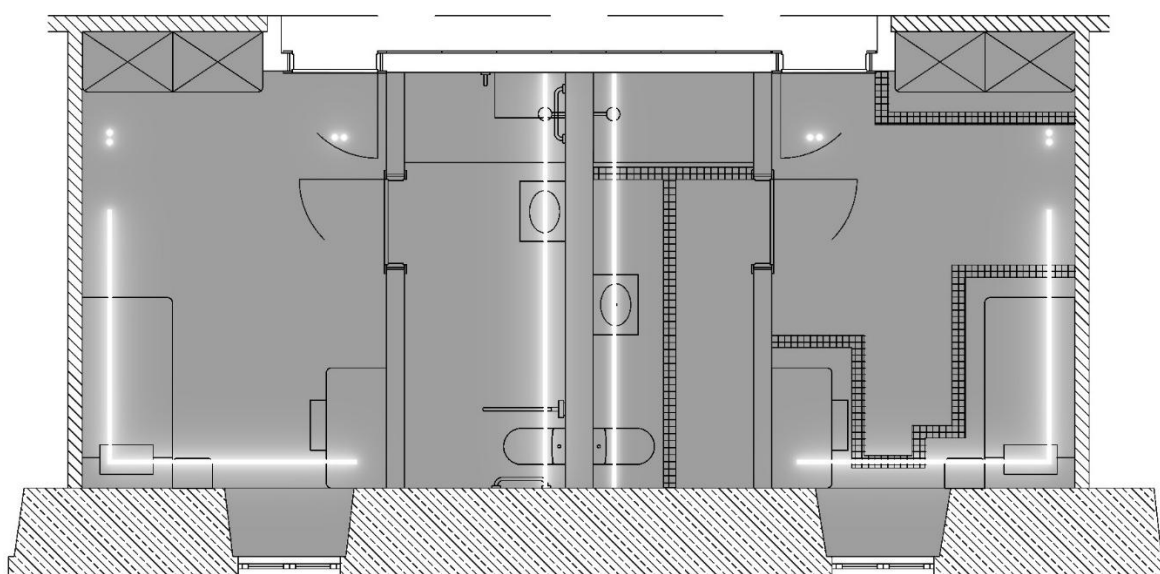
Planta de Iluminação; Fonte – Daniel Silva
